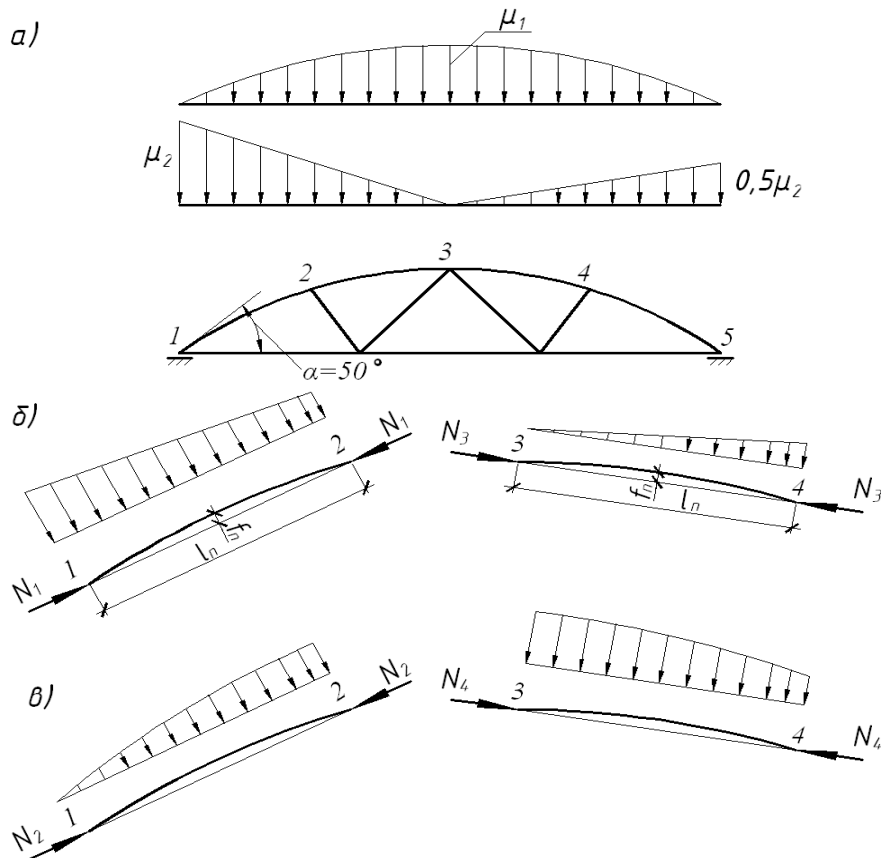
Схеми снігового навантаження на фермі і розрахункові схеми панелей верхнього пояса
